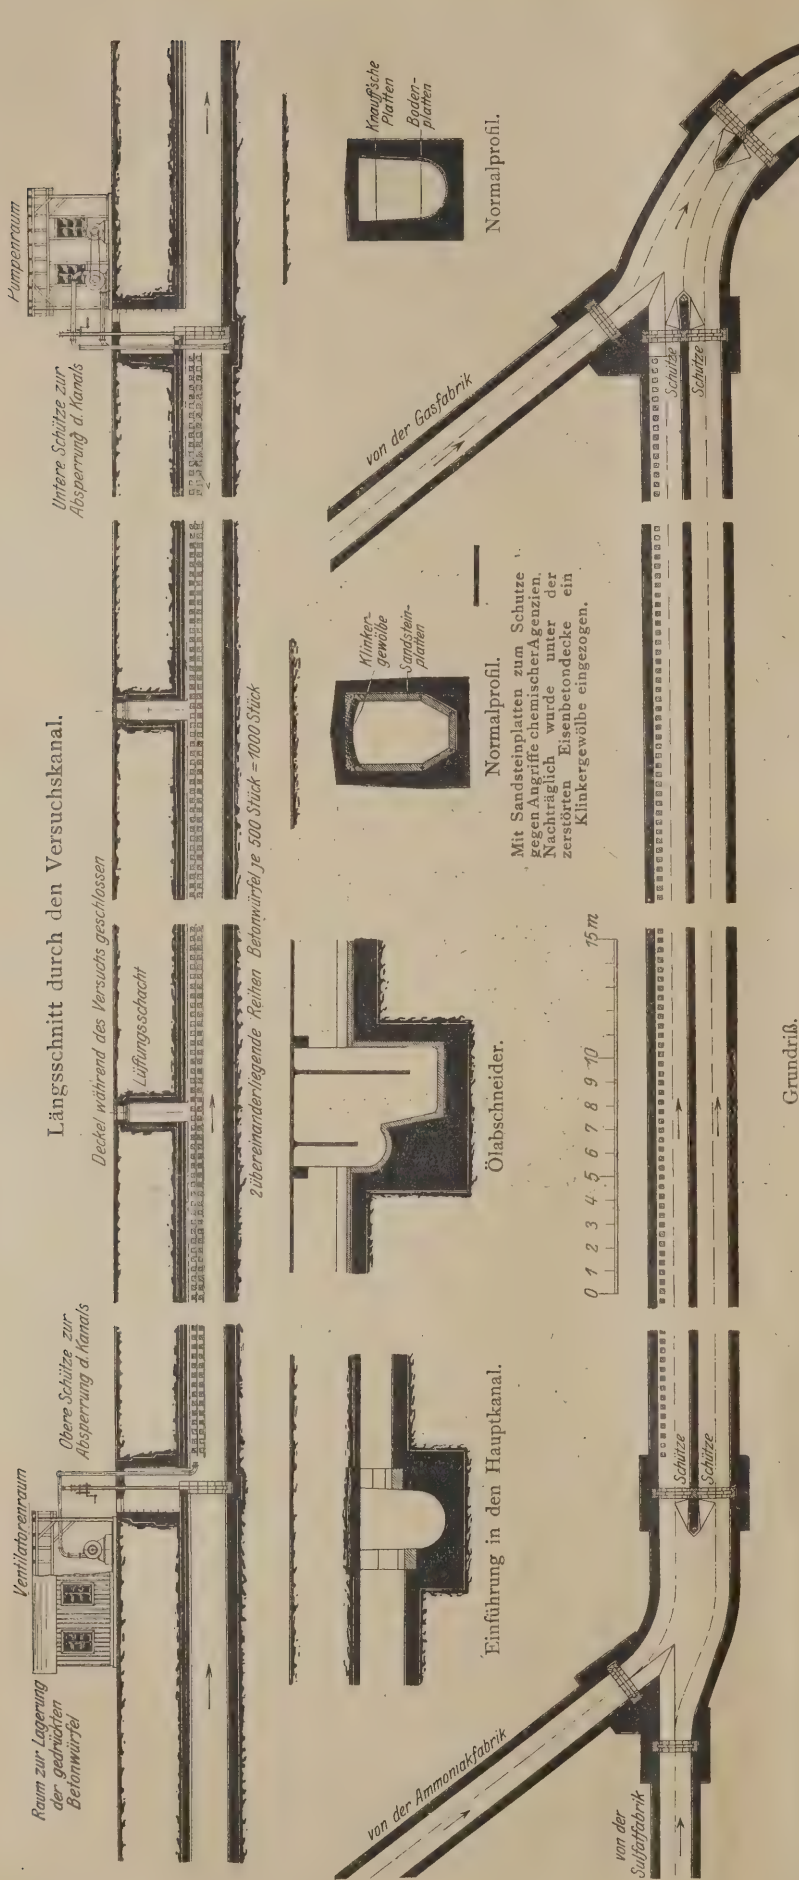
Zementversuche der B.A.S.F. Einlagerung der Betonwürfel 20/20/20 cm im bestehenden Kanal.
